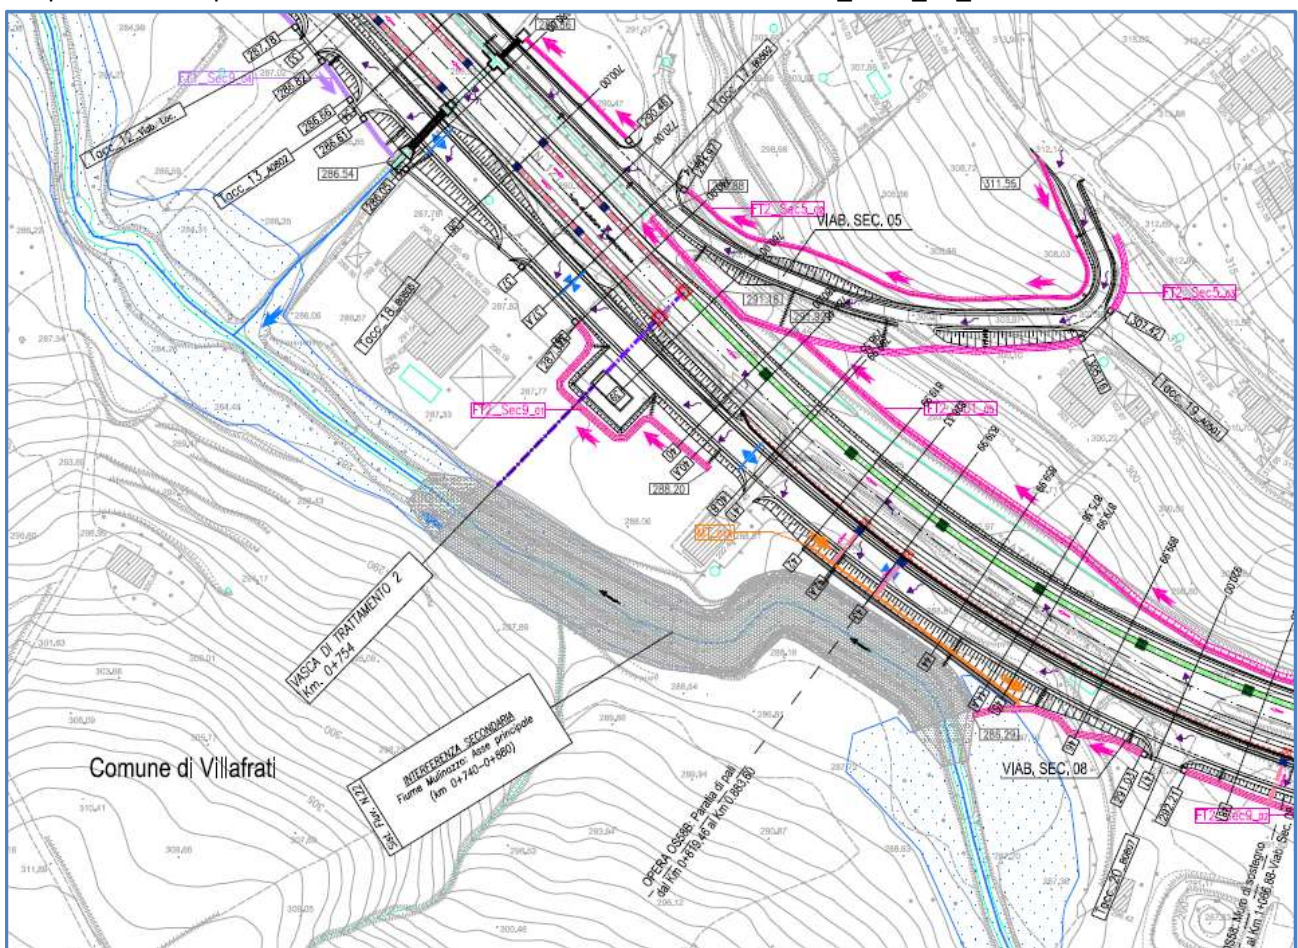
Stralcio planimetrico dell'elaborato di P.V.T.2 – codifica PEID_P001_50_4137.
